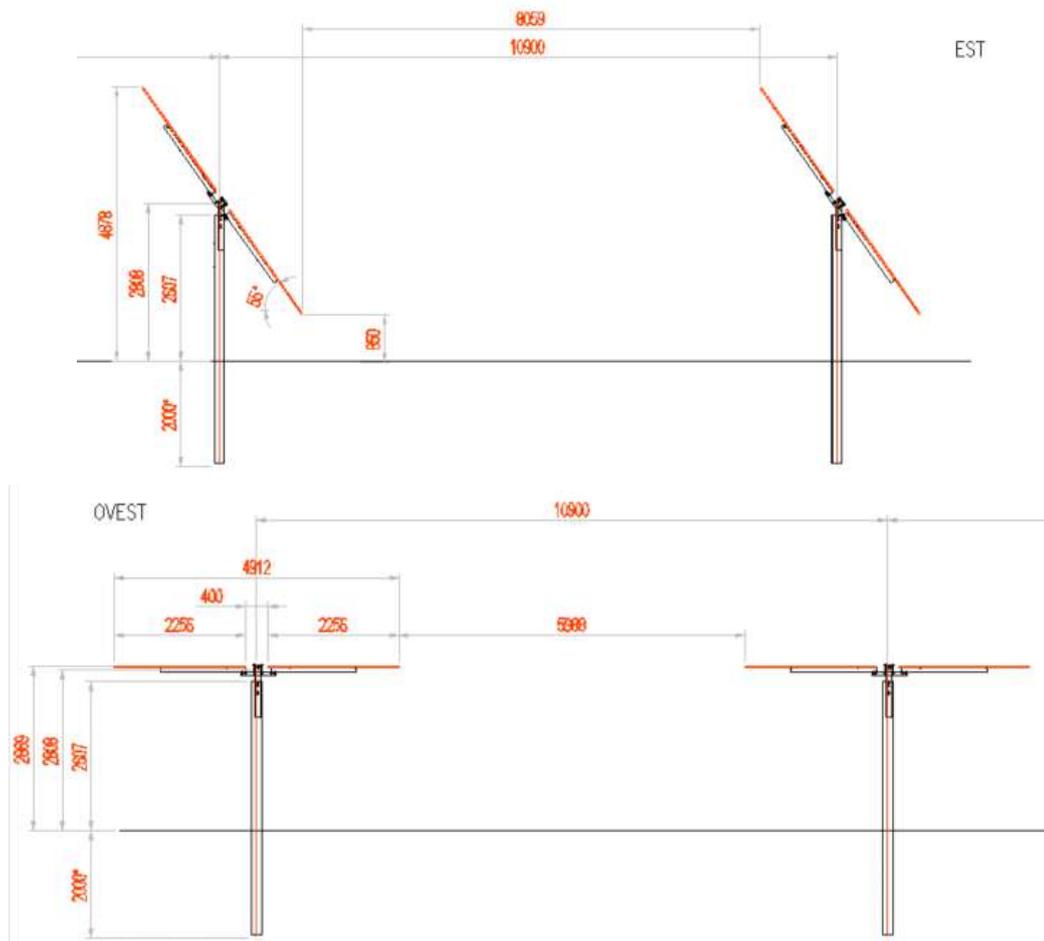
Particolare strutture di sostegno moduli – sezione trasversale
